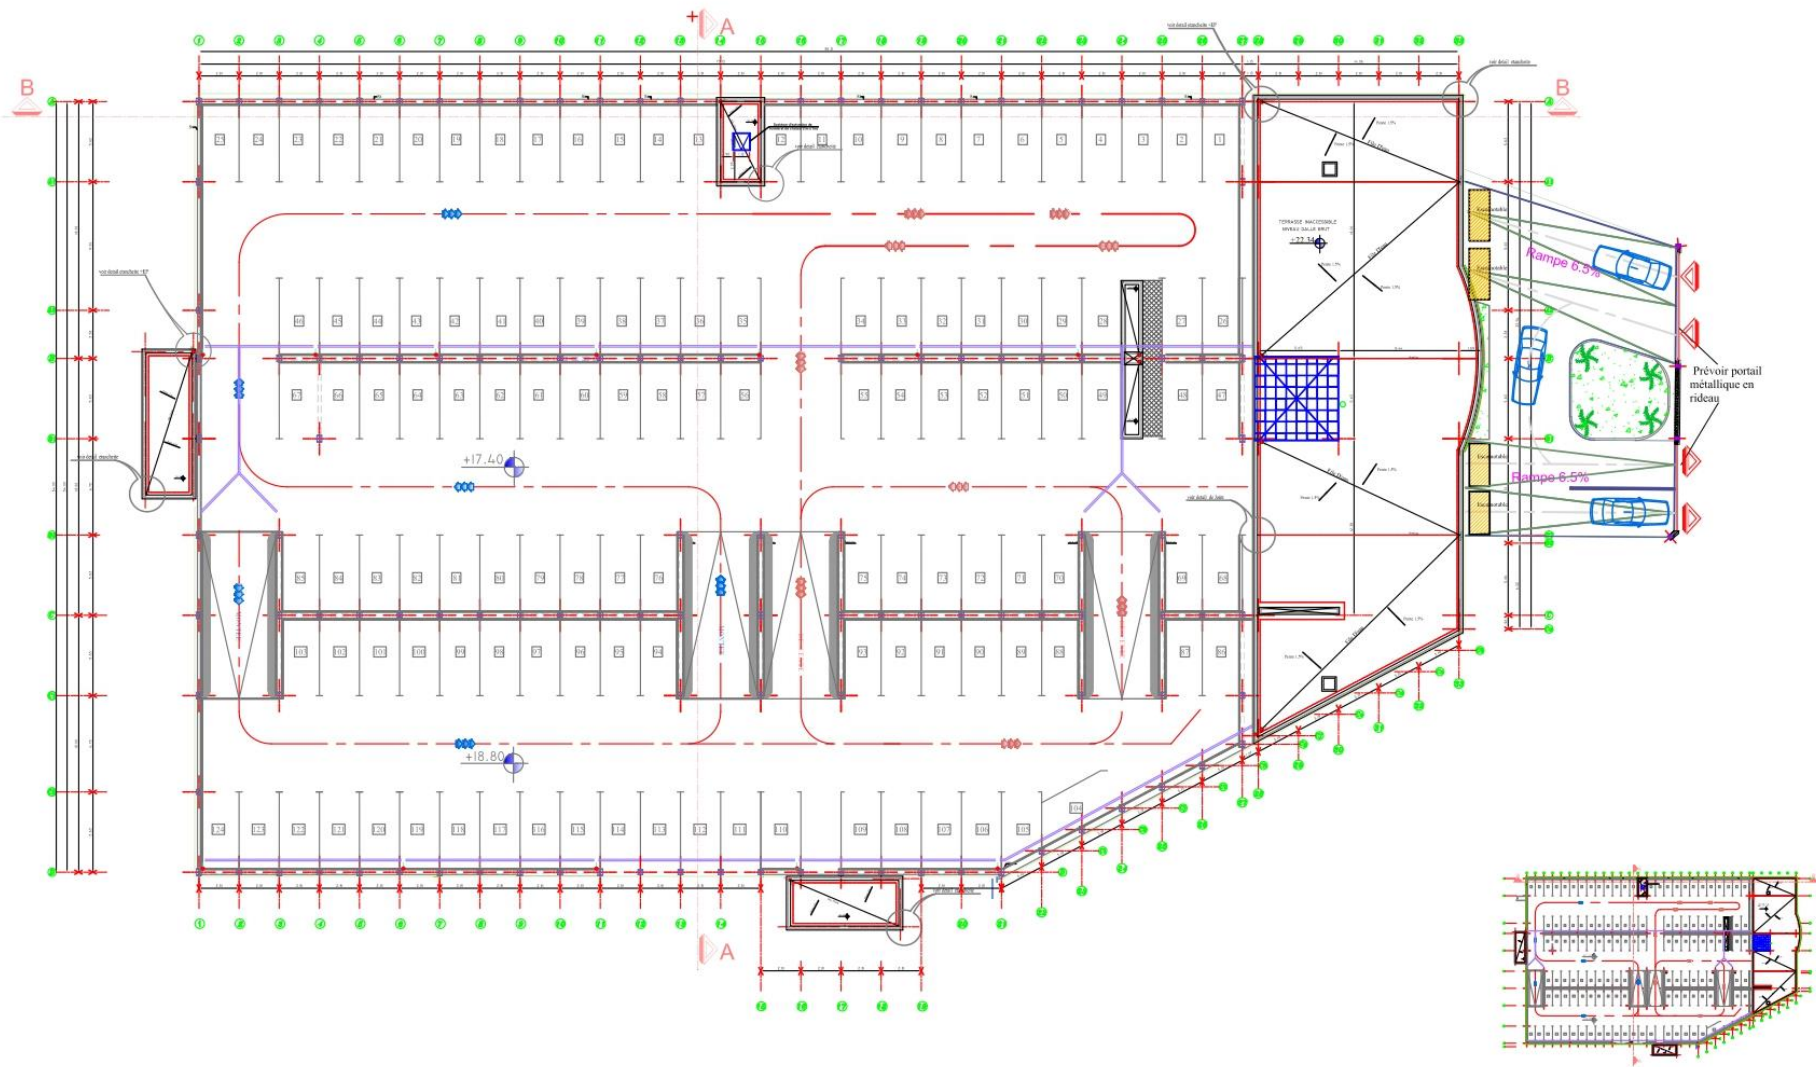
Plan d'architecture de la terrasse [Autodesk AutoCAD 2023]
